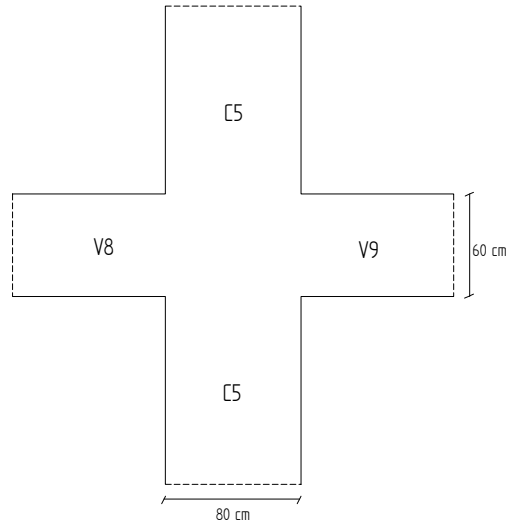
Nudo formado por columna C5 y vigas V8 y V9
